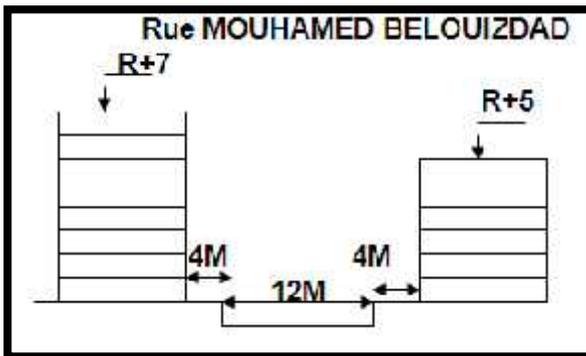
Coupe sur Belouizdad ; source : travail personnel
